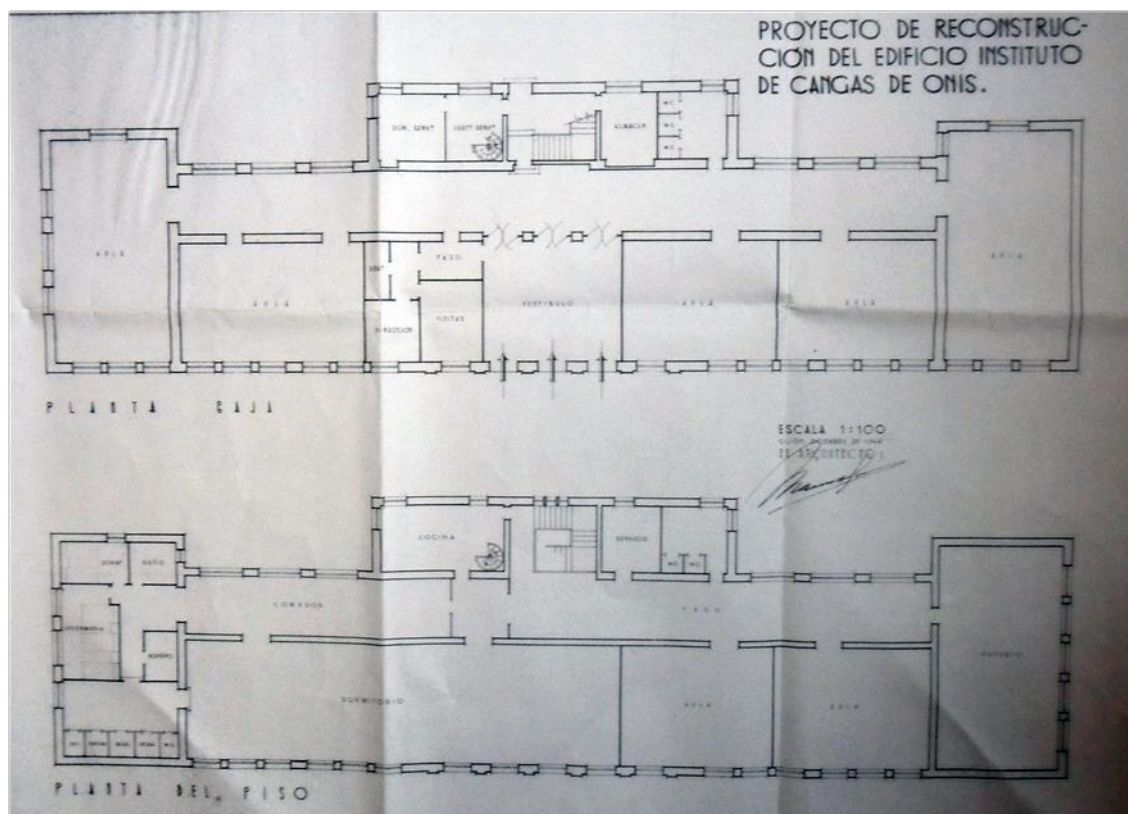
Plano del proyecto de reconstrucción del instituto de Cangas de Onís. AGA, Exp. 76/04/1778.
